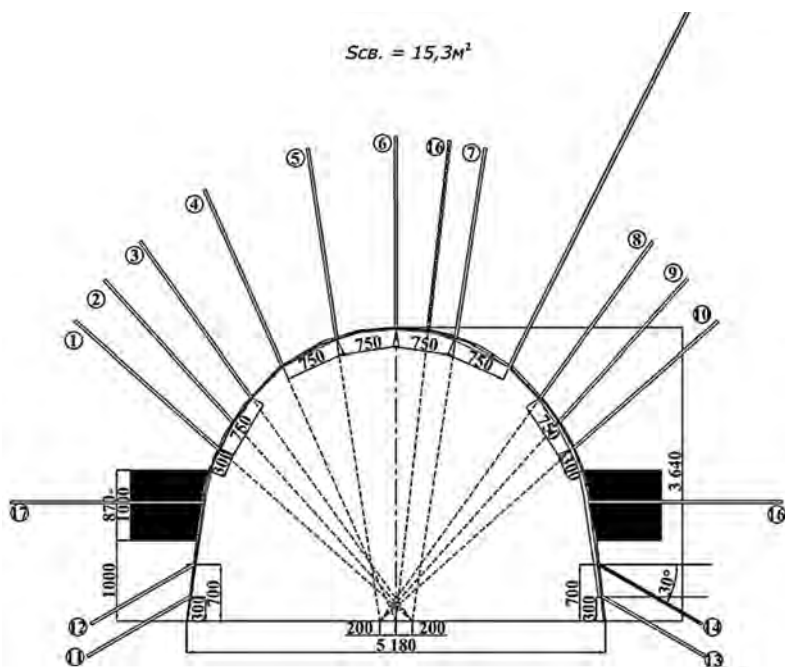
Паспорт крепления выработки: 5, 6, 7 – силовая часть перекрытия выработки; 3, 4, 8, 16 – подпорная часть перекрытия выработки; 1, 2, 9, 10, 16, 17 – опоры перекрытия выработки; 11–14 – основание конструкции; 15 – канатные анкера
